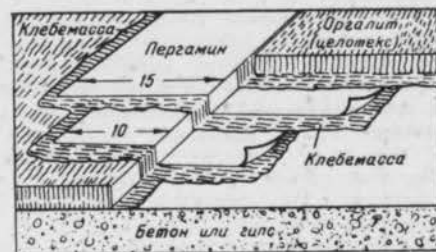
Изоляция отдельных участков крыши с утеплением из плит оргалита (целотекса) путем наклейки полосок пергамина
